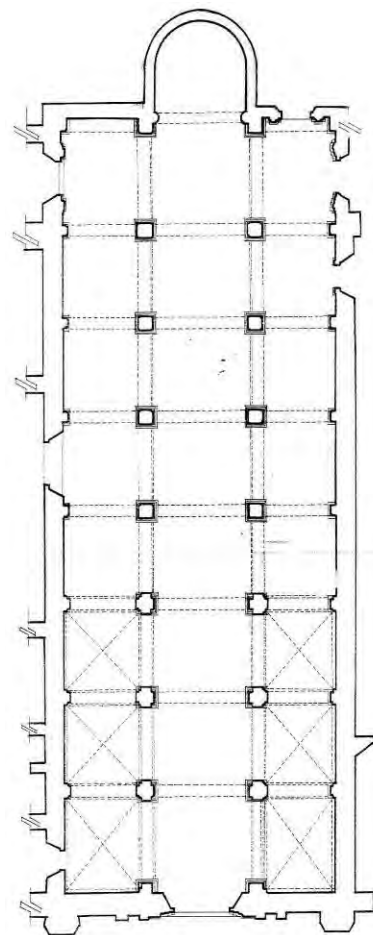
Planta arquitectónica realizada con base al levantamiento de 1923.³⁵⁵ El dibujo representa el diseño de una planta basilical caracterizada por su planta rectangular, ábside semicircular y transepto.
